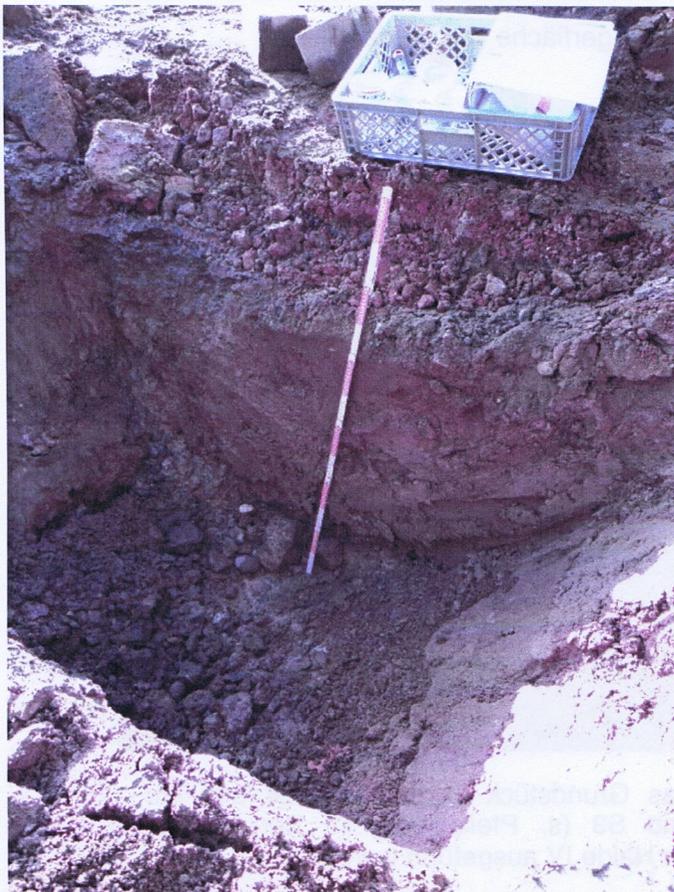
Baggerschurf S5 (ehemalige Lagerfläche von Halde III).
